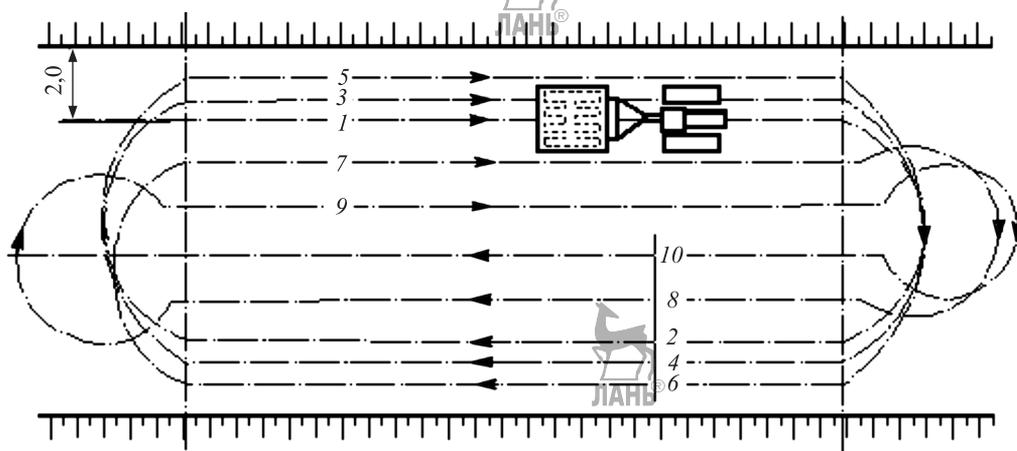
Схема работы прицепного катка на пневматических шинах:
